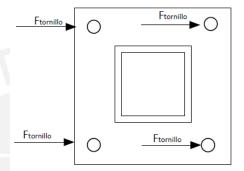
DCL de fuerza cortante en los tornillos de anclaje Hilti Fuente: Elaboración propia
